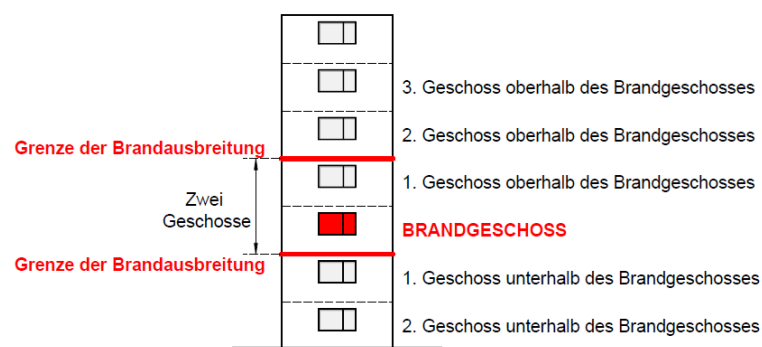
Darstellung des Schutzziel für Fassaden in Österreich – „zwei Geschosse“
